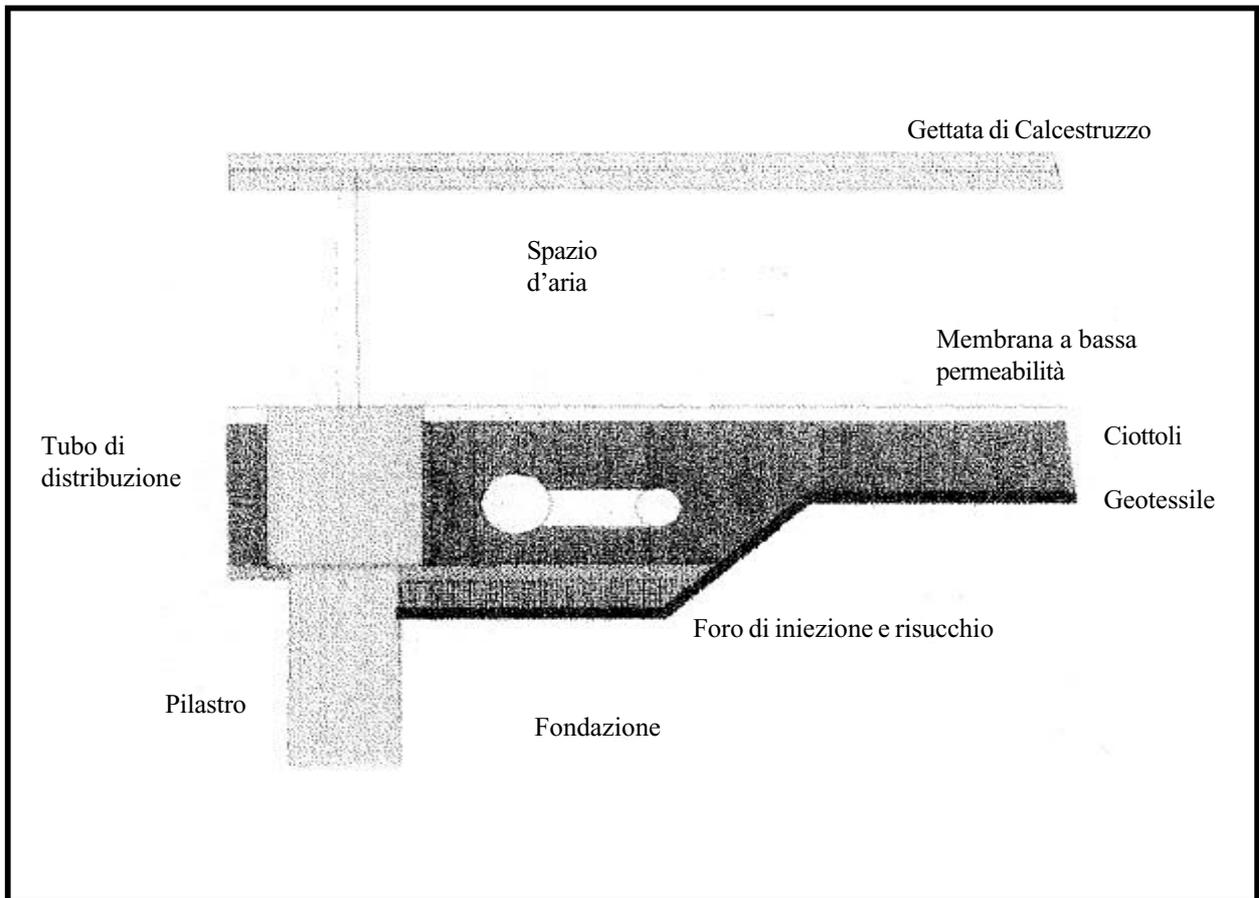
Sezione del piano di costruzione e sistema di ventilazione del gas
